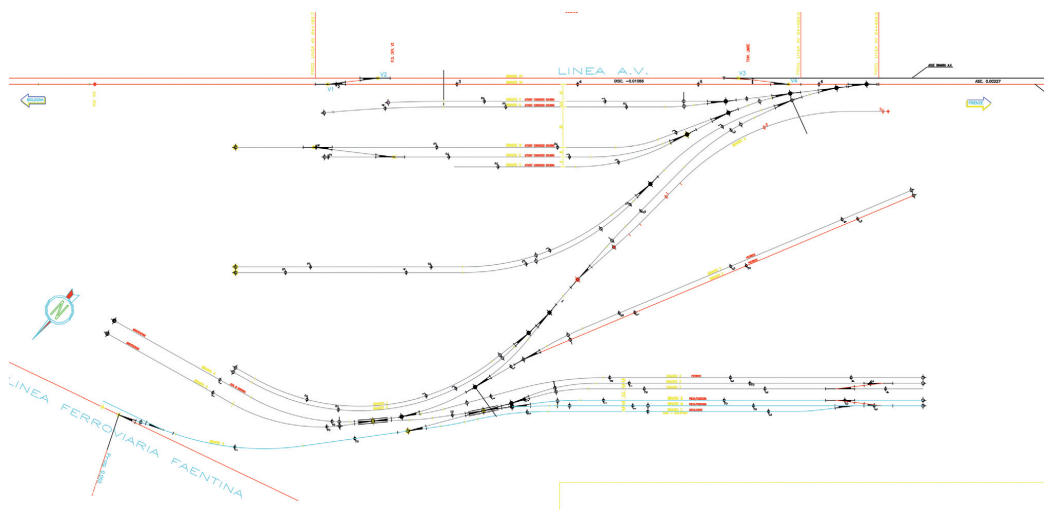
Planimetria Cantiere di armamento CAR1 in località S. Piero a Sieve. *Layout of the permanent way yard CAR1 in the area of S. Piero a Sieve.
